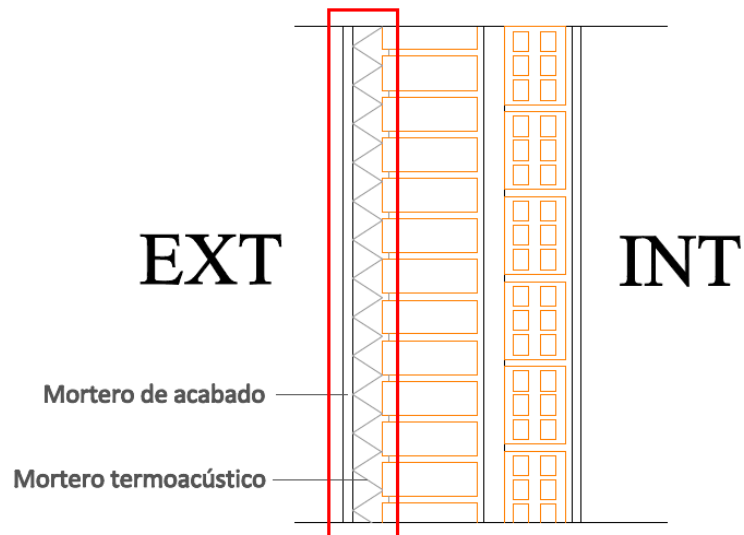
Detalle de solución exterior con mortero termoaislante en fachada de doble hoja.
